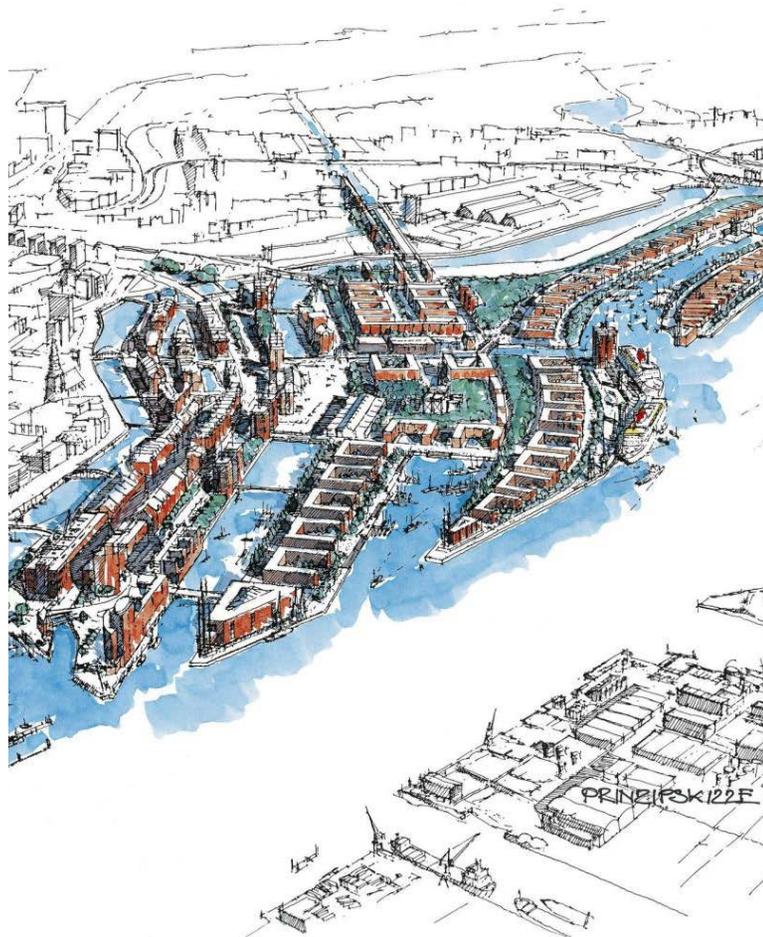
Abb. XXXI Lageplan Entwurf 1979 von Architekten Gerkan, Marg und Partner
